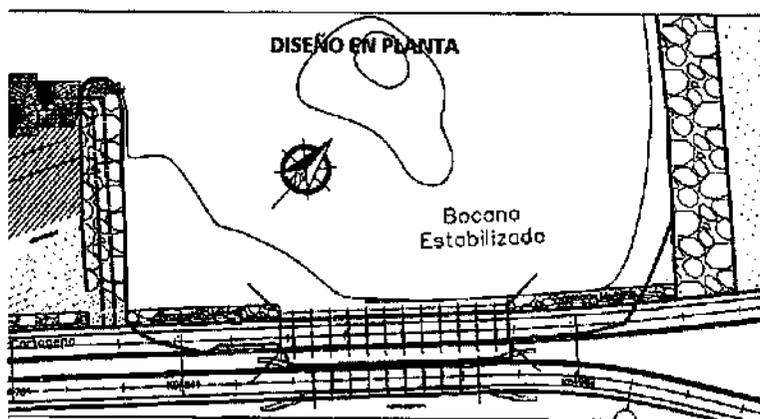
Planta constructiva barrera de apoyo semi-sumergida (plano 5).
